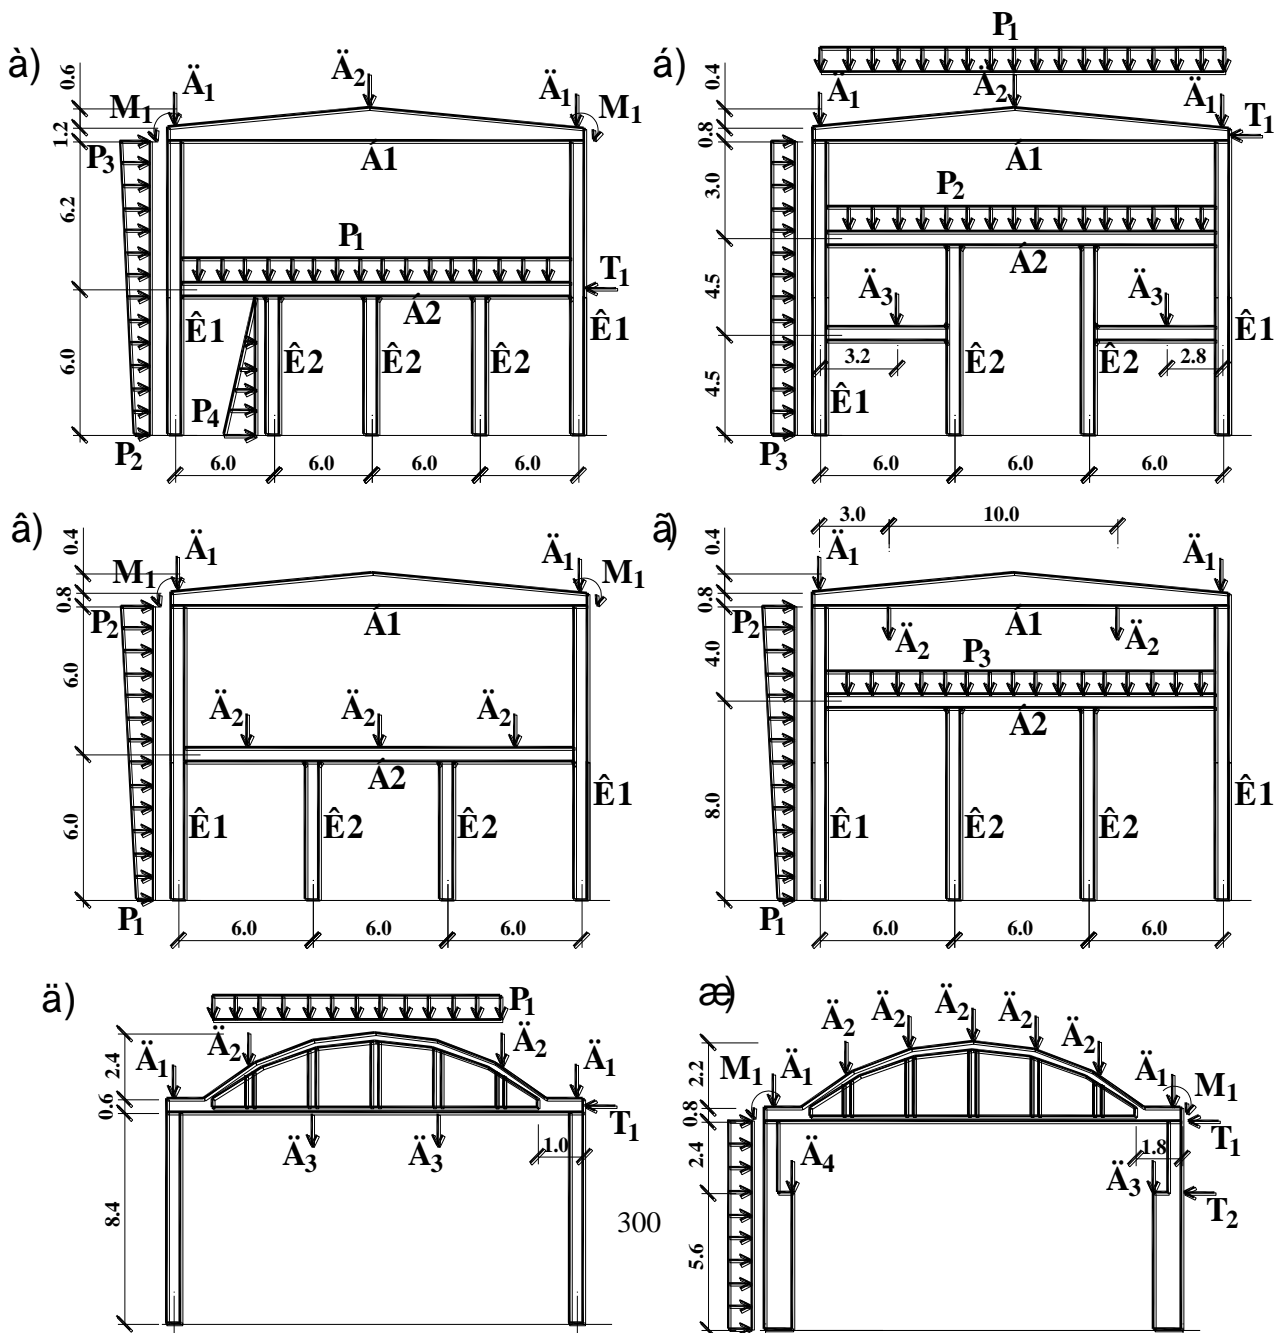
Розрахункові схеми залізобетонних рам.
